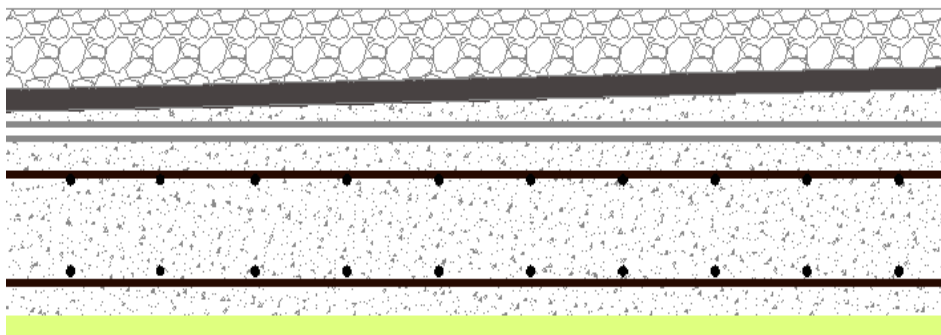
Composants d'un plancher terrasse en dalle pleine.
